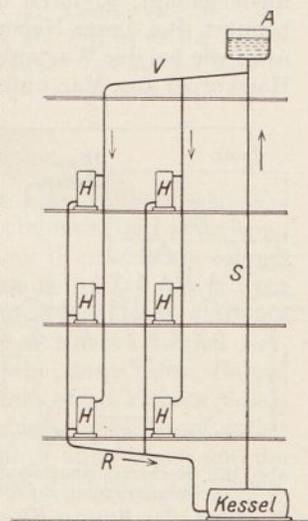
Plan einer Warmwasserheizung mit oberer Verteilung. Querschnitt durch mehrere Stockwerke.
